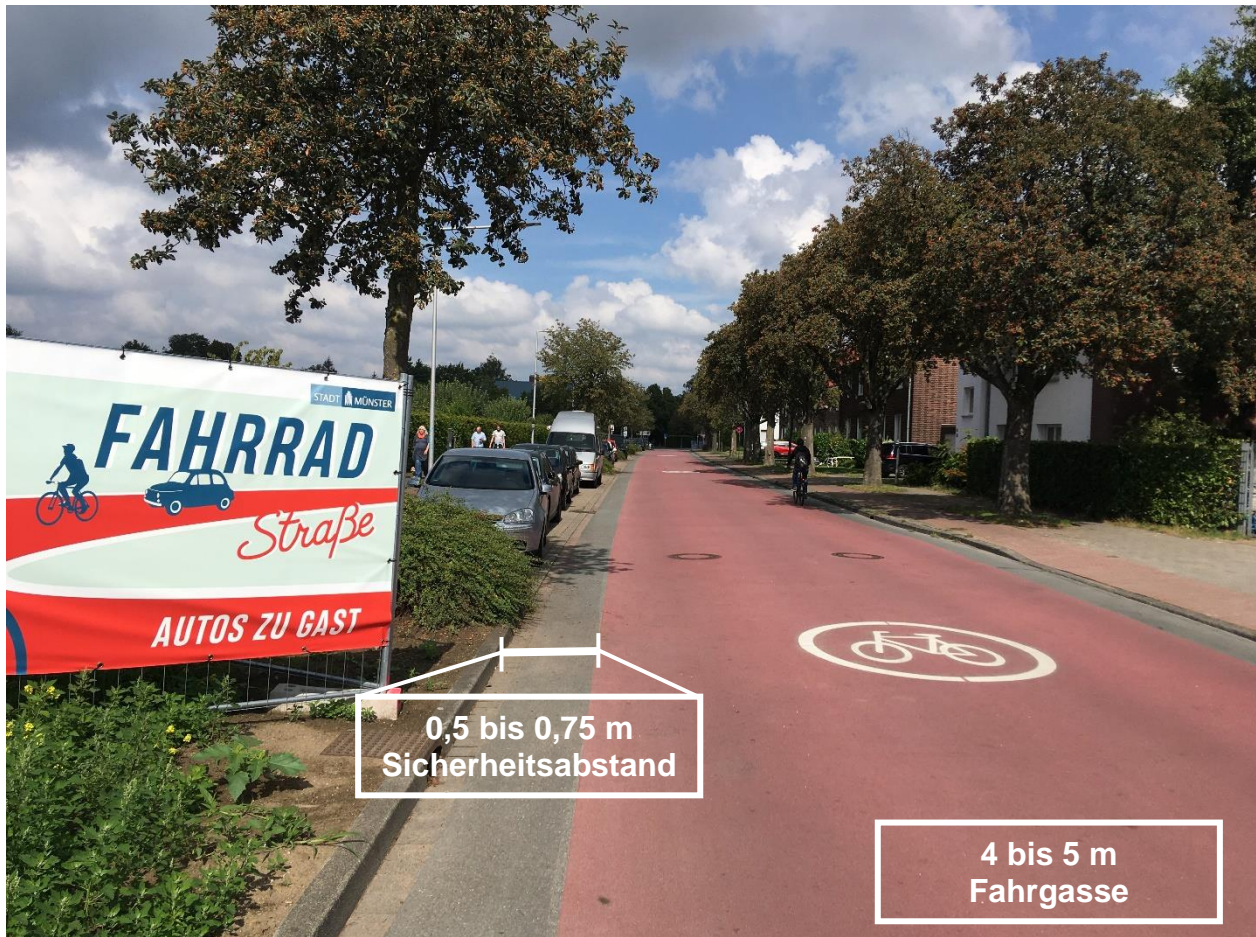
Fahrradstraße Dieckstraße (Foto Stadt Münster)
